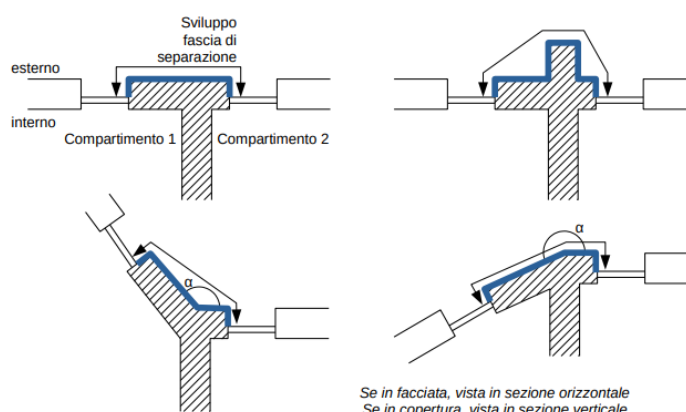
Esempi di fascia di separazione verticale in facciata o in copertura
